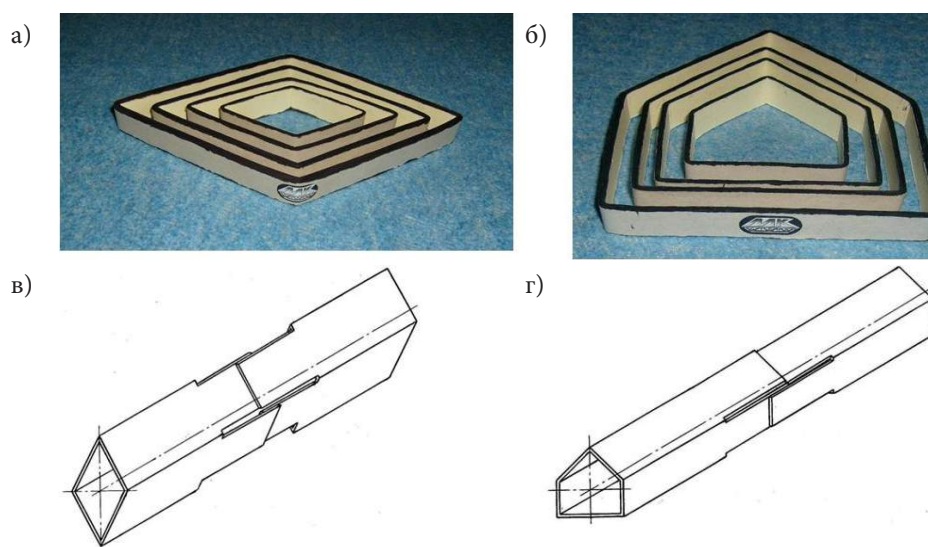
Профили поперечных сечений стержневых трубчатых элементов ромбической (а) и пятиугольной (б) формы, а также их стыковые сварные соединения в процессе монтажа (в, г)
